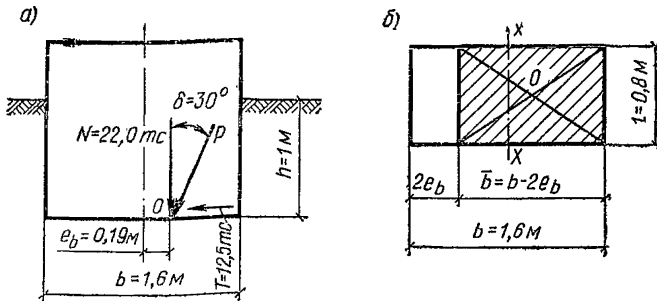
Схема к расчету несущей способности основания прямоугольного фундамента по формуле (3.92) (28)
